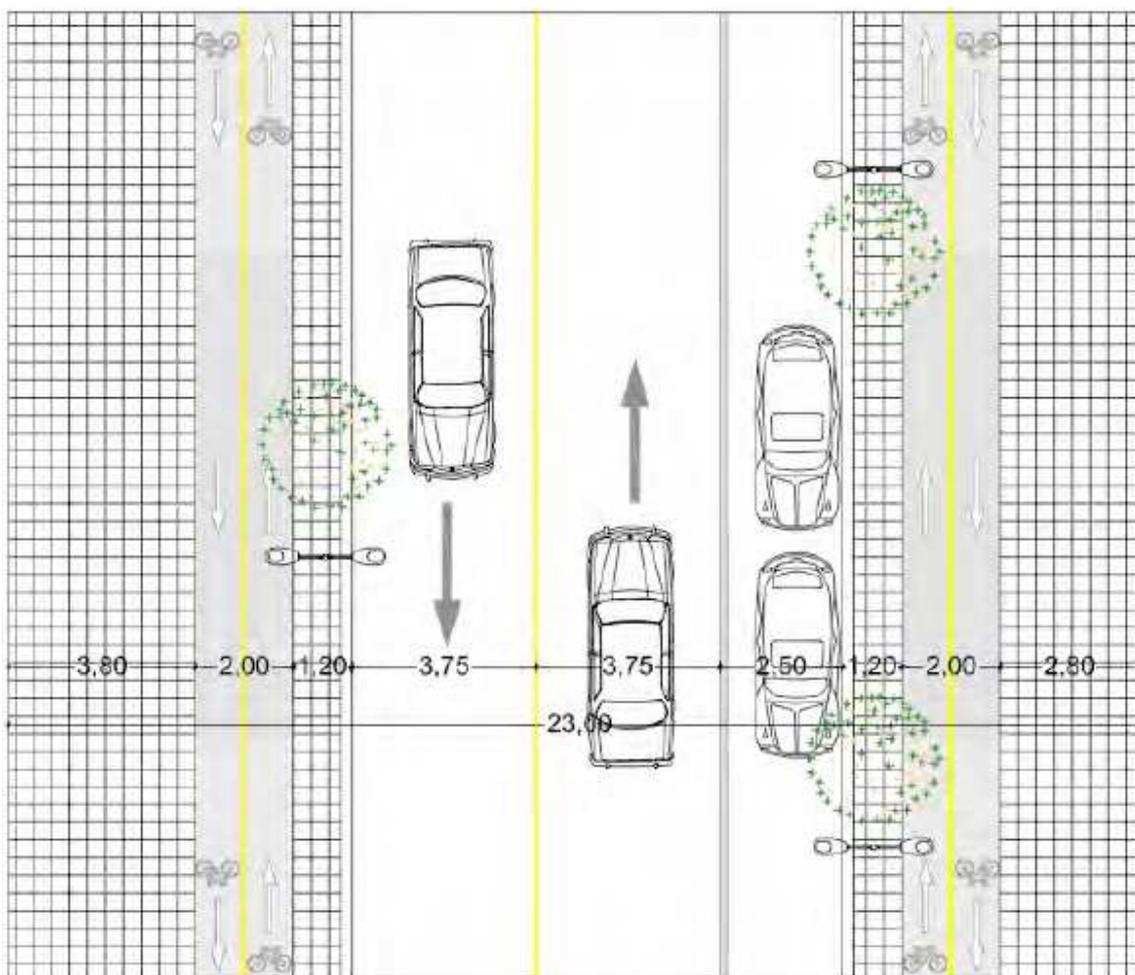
Planta Proposta para a Rua Nossa Senhora da Penha
